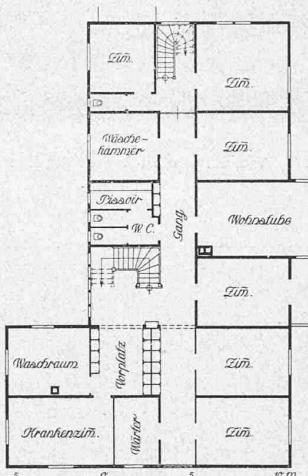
bis 16. Grundrisse der Arbeits- und Erziehungs-Anstalt „Kreckelhof“ in Herisau. — Masstab 1 : 400.
